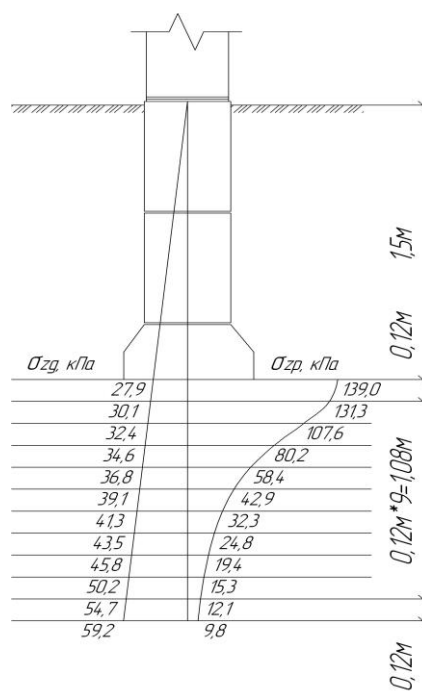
Схема к расчету осадки ленточного фундамента под стены.
